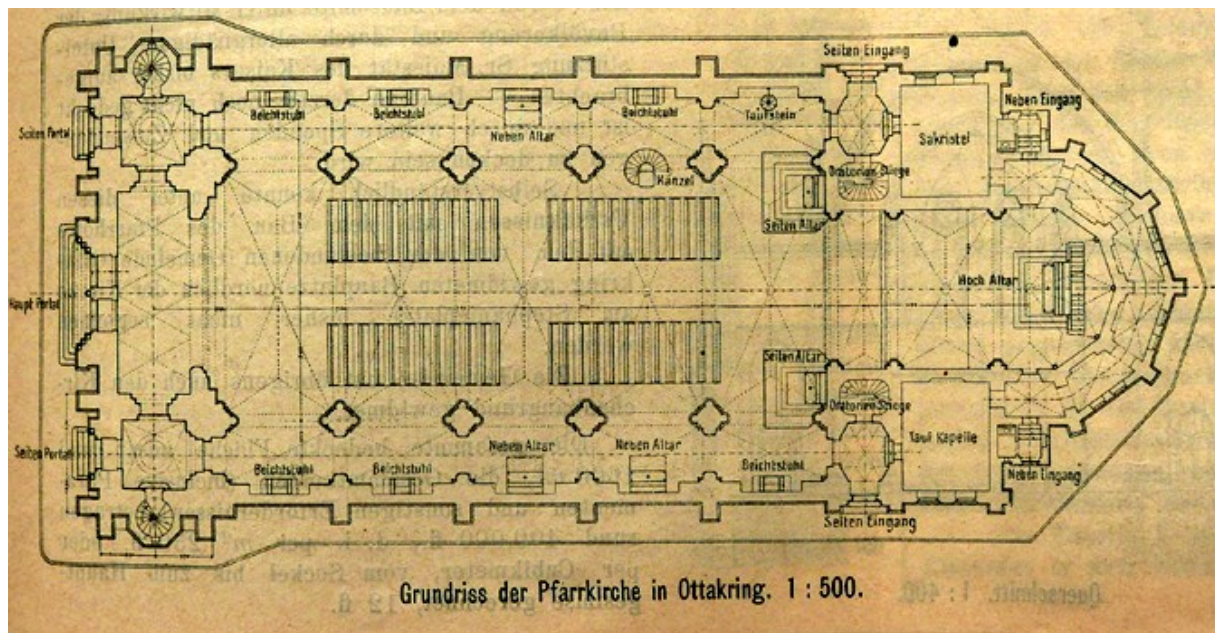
, Pfarrkirche Neuottakring, Grundriss, reproduziert nach ZÖIAV, 1899.
